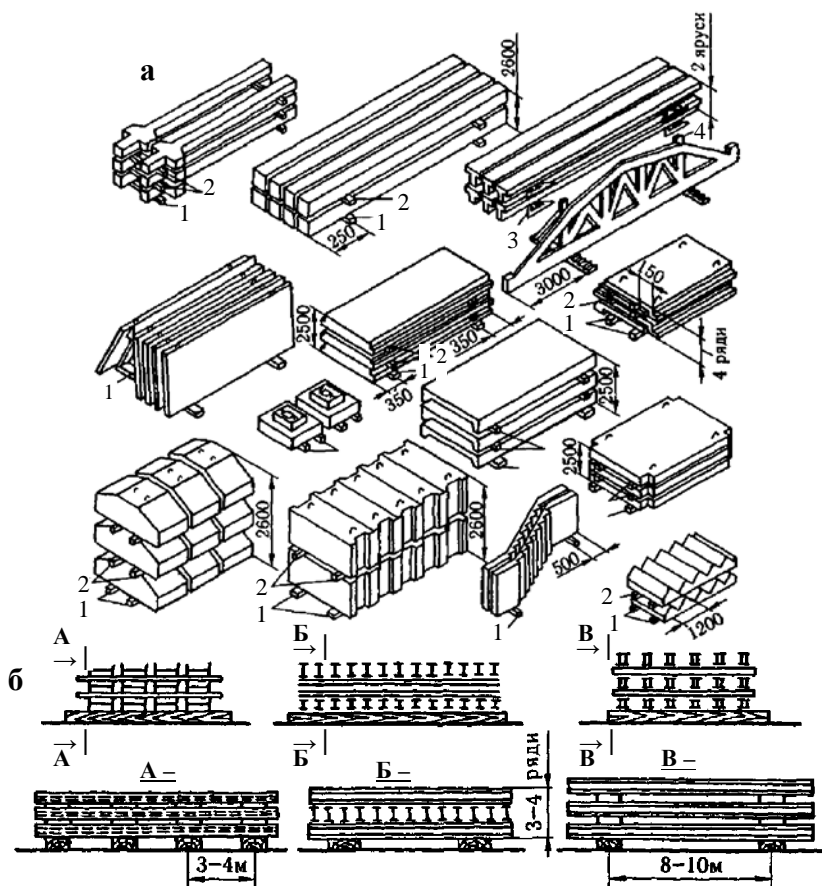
Складування будівельних конструкцій: а – залізобетонних; б – металевих; 1 – лежні-підкладки; 2 – прокладки; 3 – металеві опори; 4 – касета
